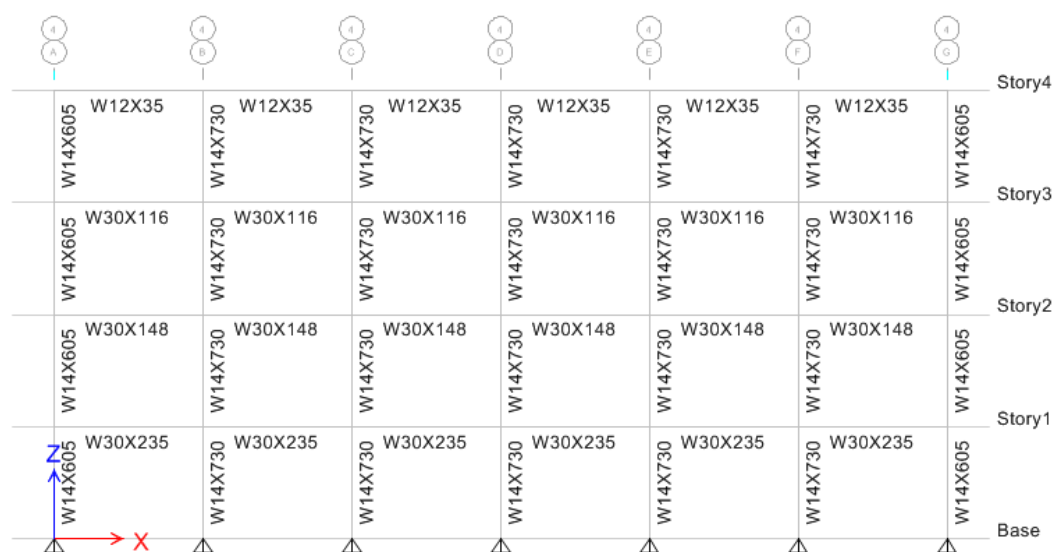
Pórtico 4 – Estructura sin arriostamiento
